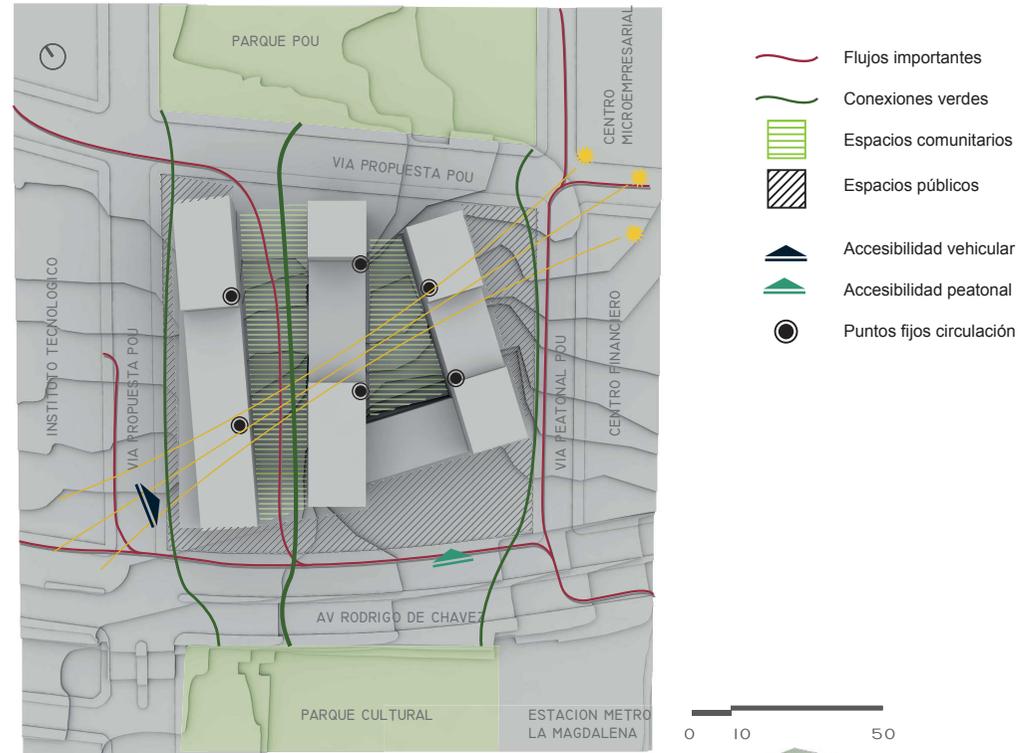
Propuesta 1 plan masa - implantación y estrategias
